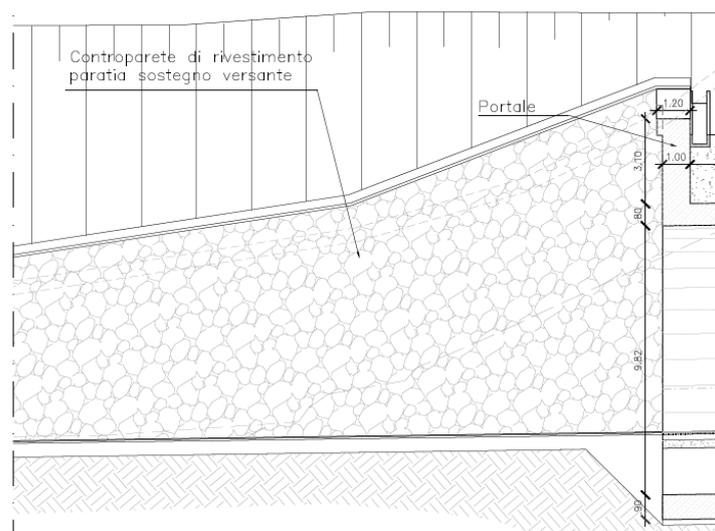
Muro di controripa nel tratto Ovest di fine lotto in continuità a portale di imbocco della galleria: prospetto
